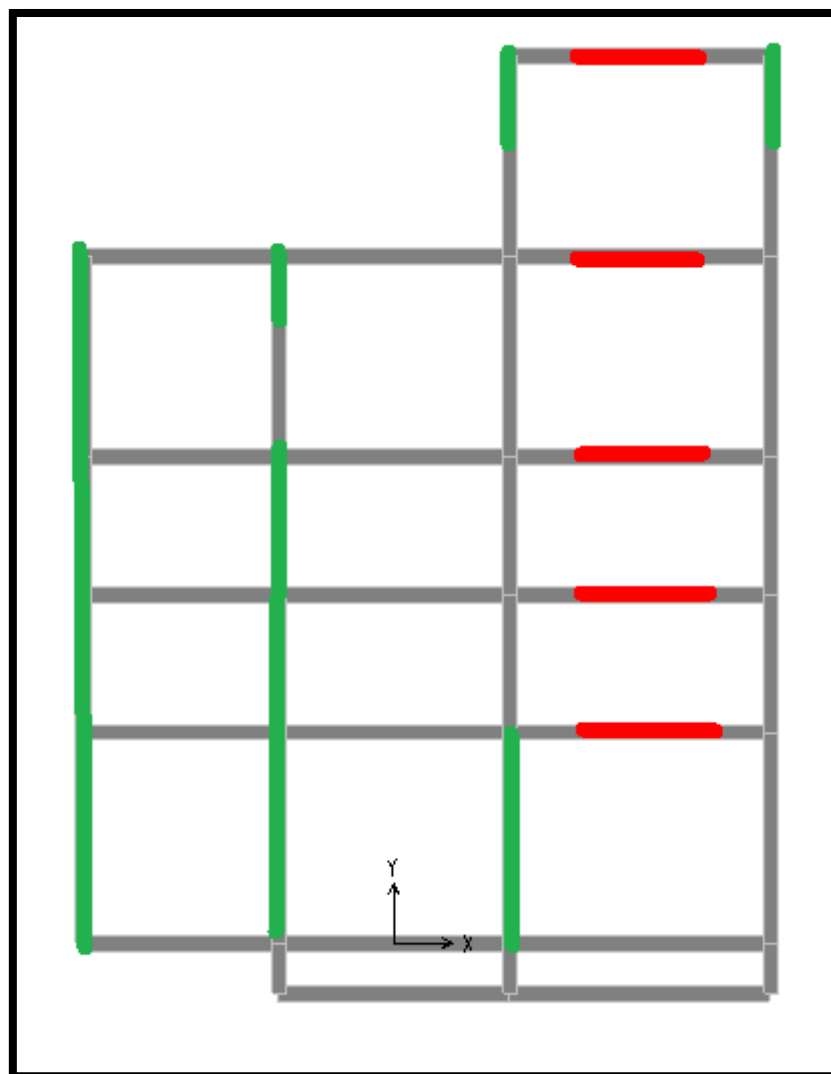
Vérification du ferrailage des poutres principales et des chaînages ($Z=7.45$ m)
